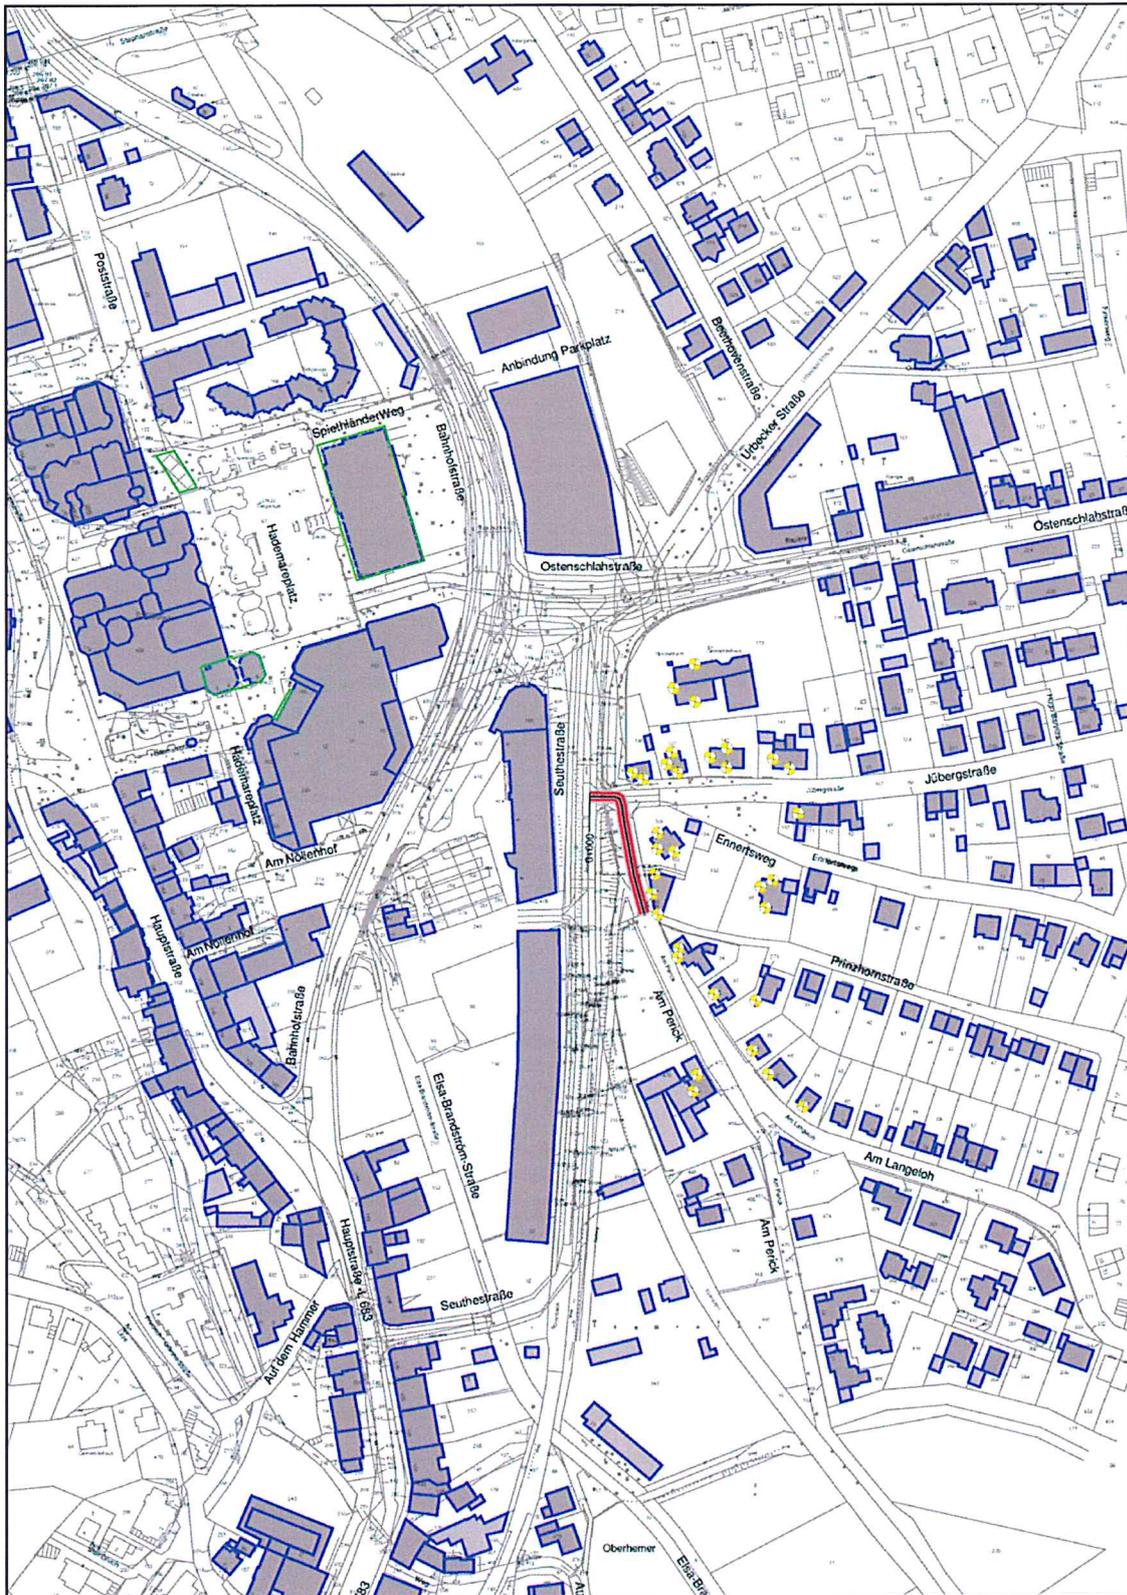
Lageplan und Immissionsorte der Straße Am Perick
